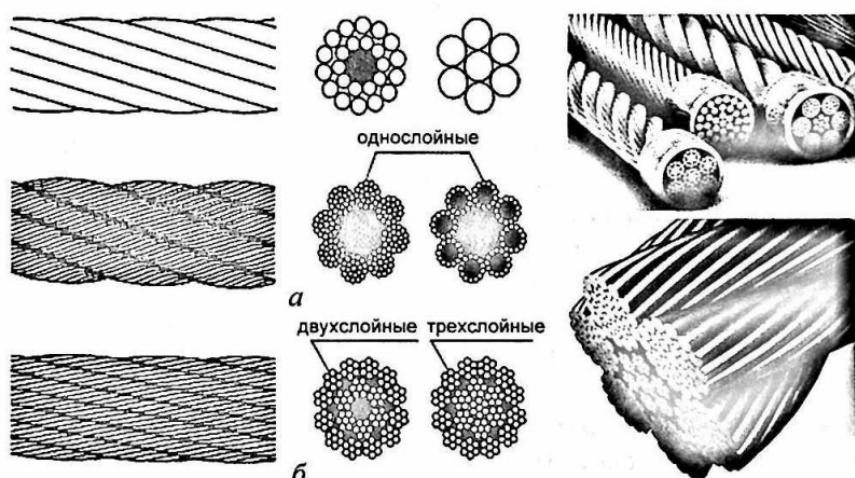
Прядевая канатная арматура для предварительно напряженных конструкций одинарной (а) и двойной (б) свивки
